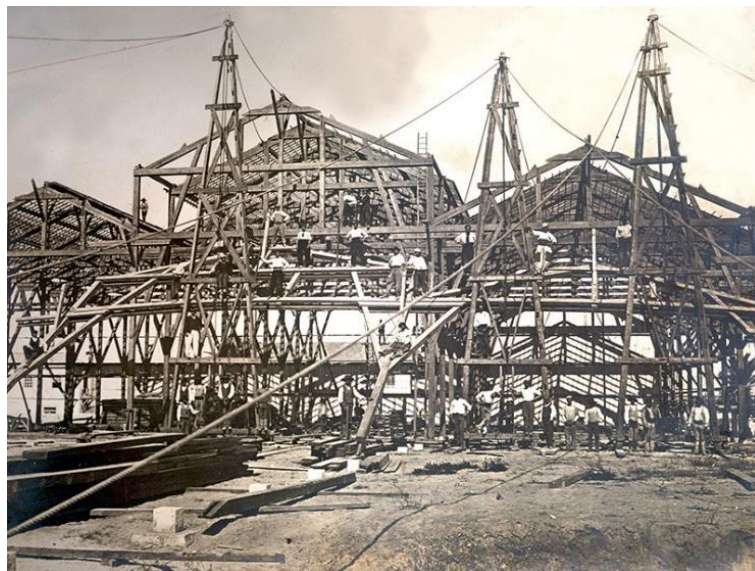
Construção do Complexo Industrial no Barreiro – 1908
